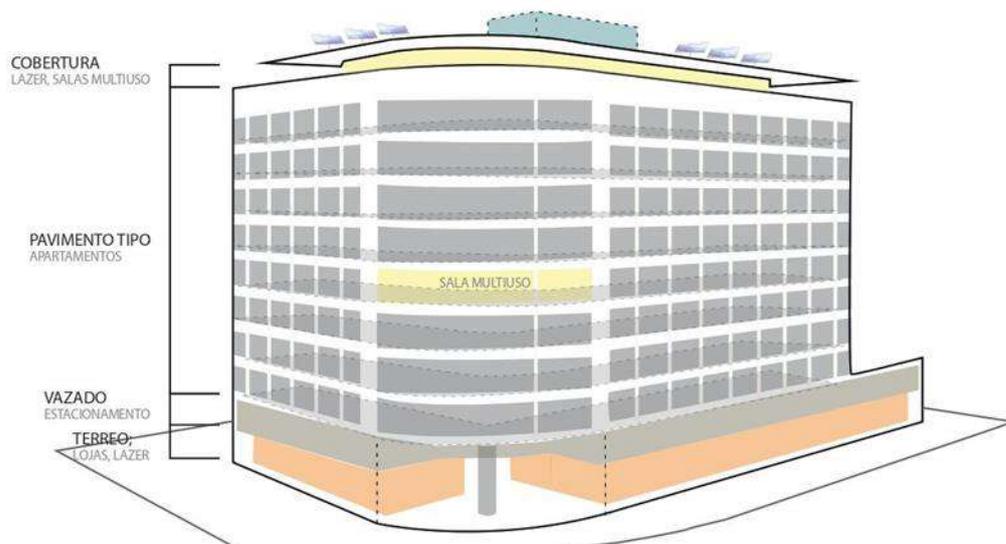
Zoneamento. (Fonte: Autoral, 2022)
